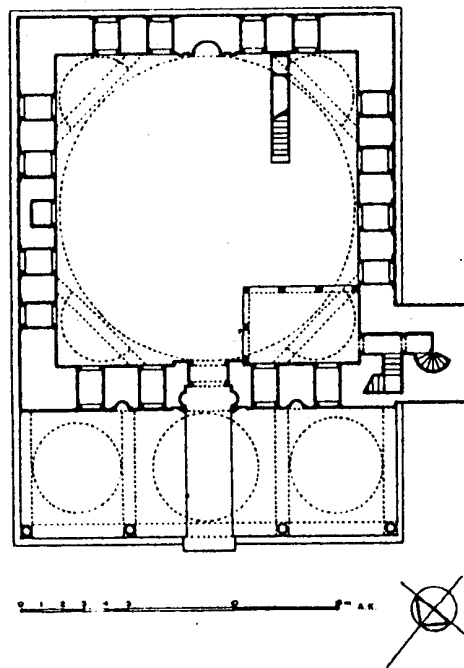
مسقط أفقي لمسجد حاجي شهاب الدين باشا في ادرنه (عن : Kuran)
